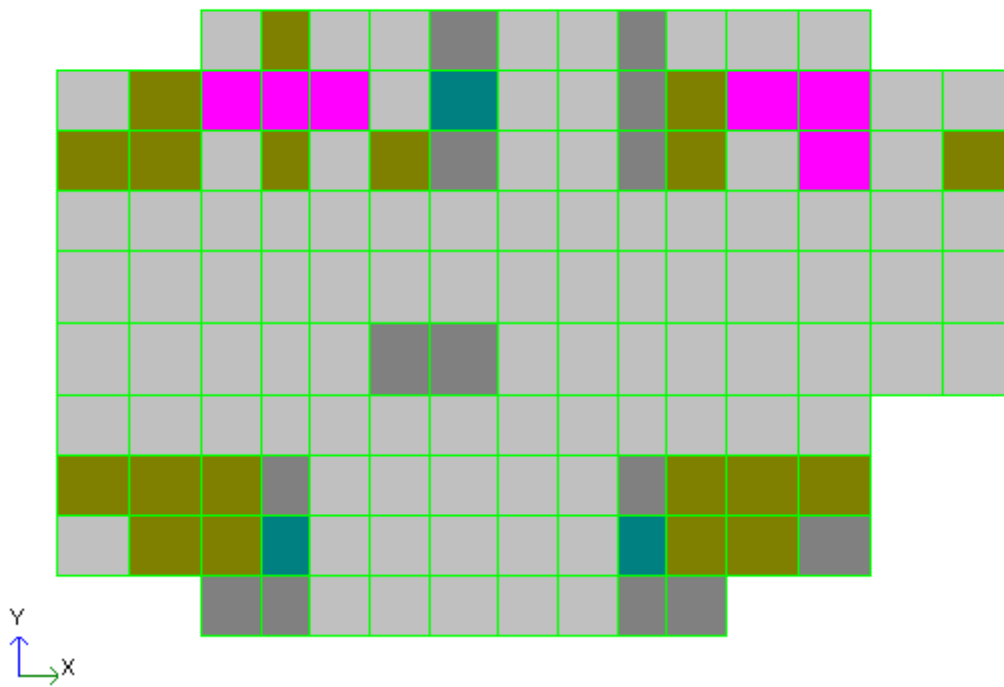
Площадь арматуры на 1 п /м по Осі Y у нижній грані
